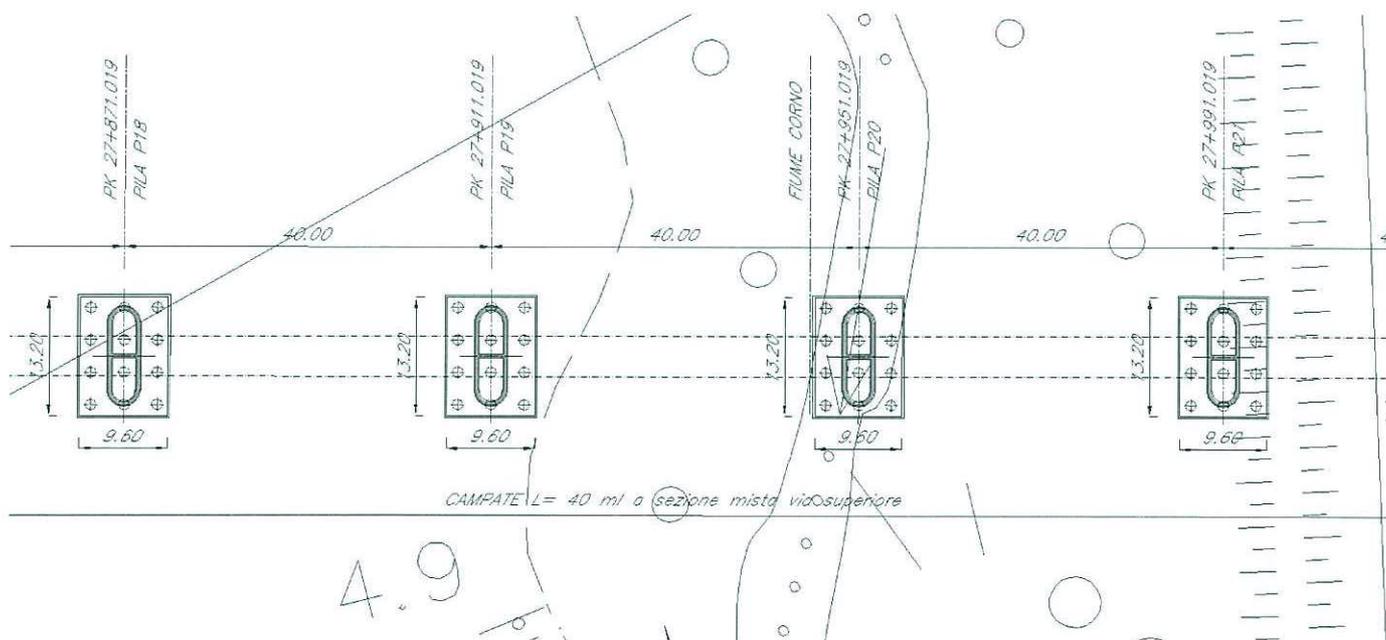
Pianta dell'attraversamento del fiume Corno.
